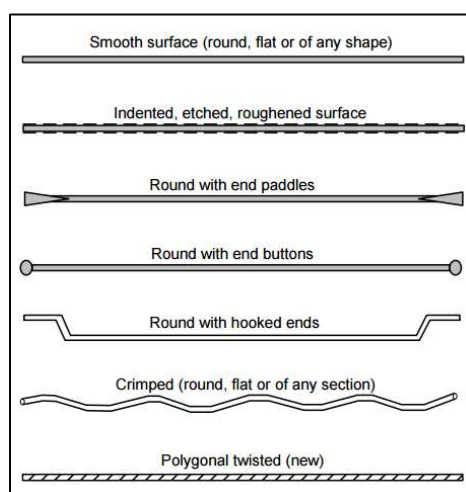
Geometrías de fibras de acero para hormigón (Naaman A. E., 2003)
